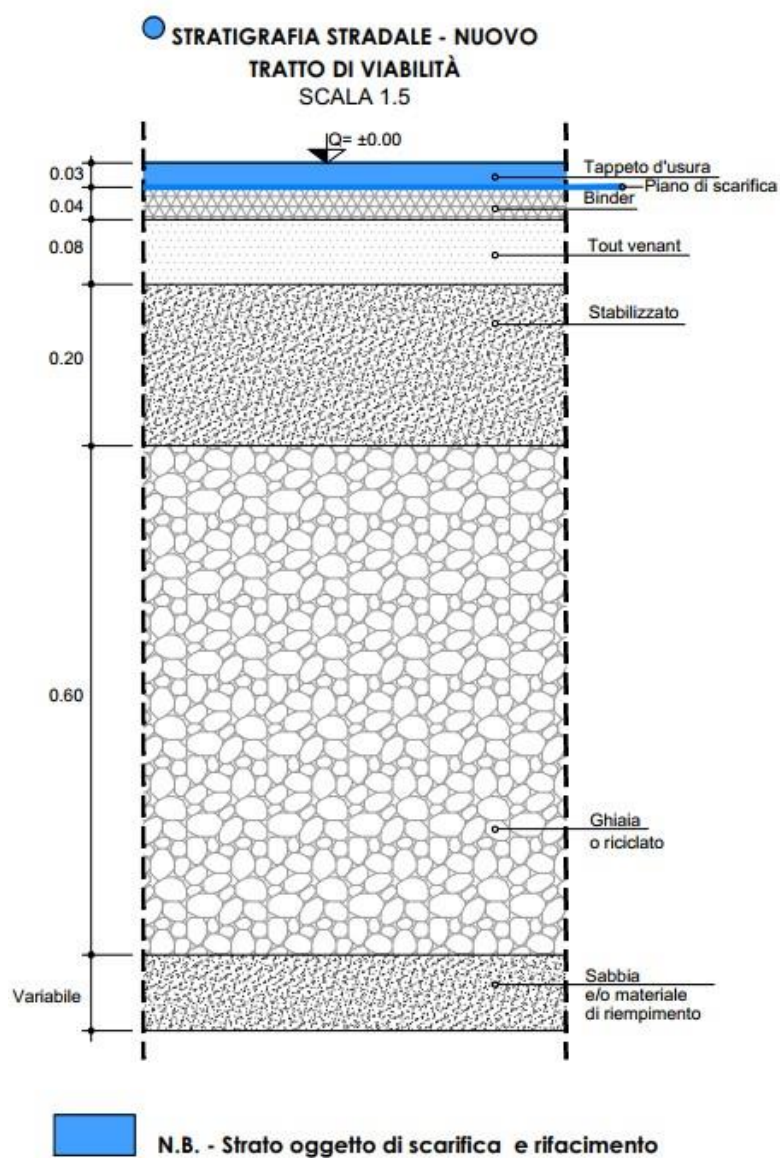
Pacchetto pavimentazione stradale oggetto di scarifica e rifacimento
